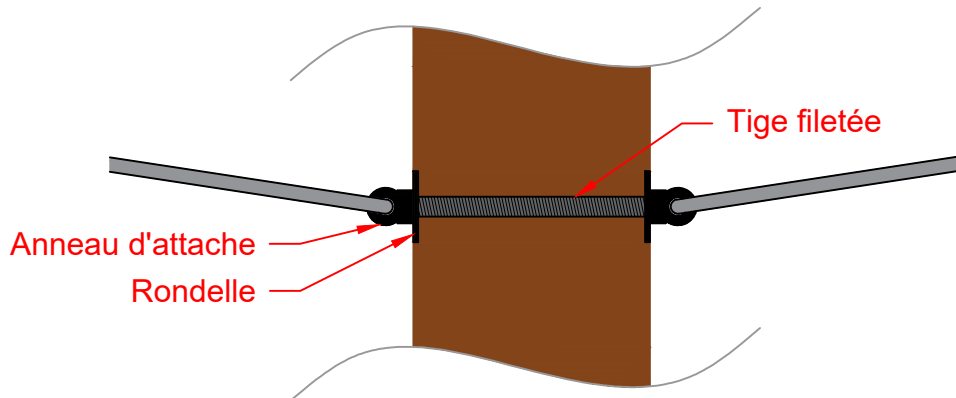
Coupe verticale de l'assemblage reliant les câbles principaux et un poteau.
